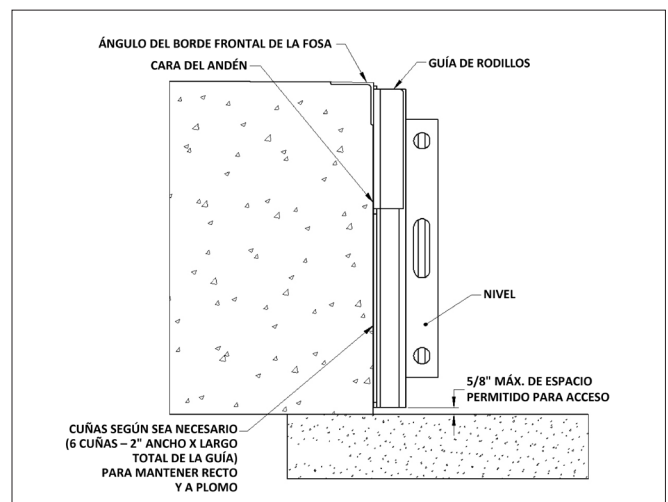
FIGURA E—VISTA LATERAL DE SOLDADURA DE LA GUÍA DE RODILLOS
